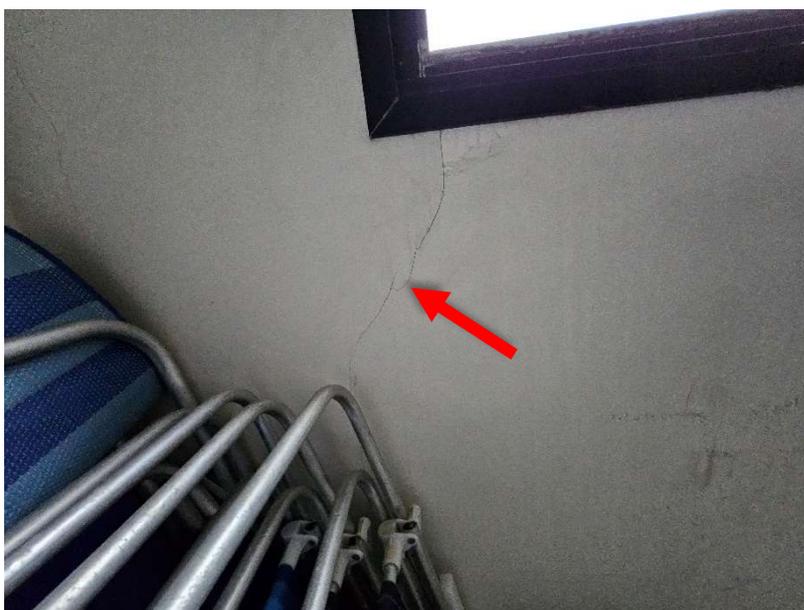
Detalhe para trinca na parede, adjacente à janela.
